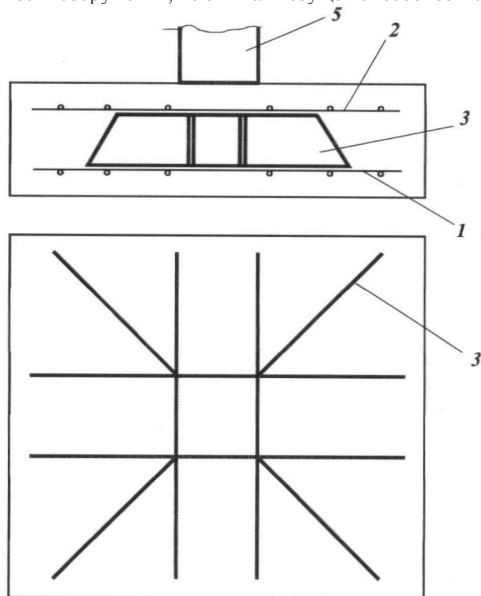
Общий вид монолитного фундамента мелкого заложения под прямоугольную колонну с присоединенной колонной [3], где: 1 – верхняя арматурная сетка; 2 – нижняя арматурная сетка; 3 – жесткие вставки; 4 – арматурные выводы; 5 – колонна.
